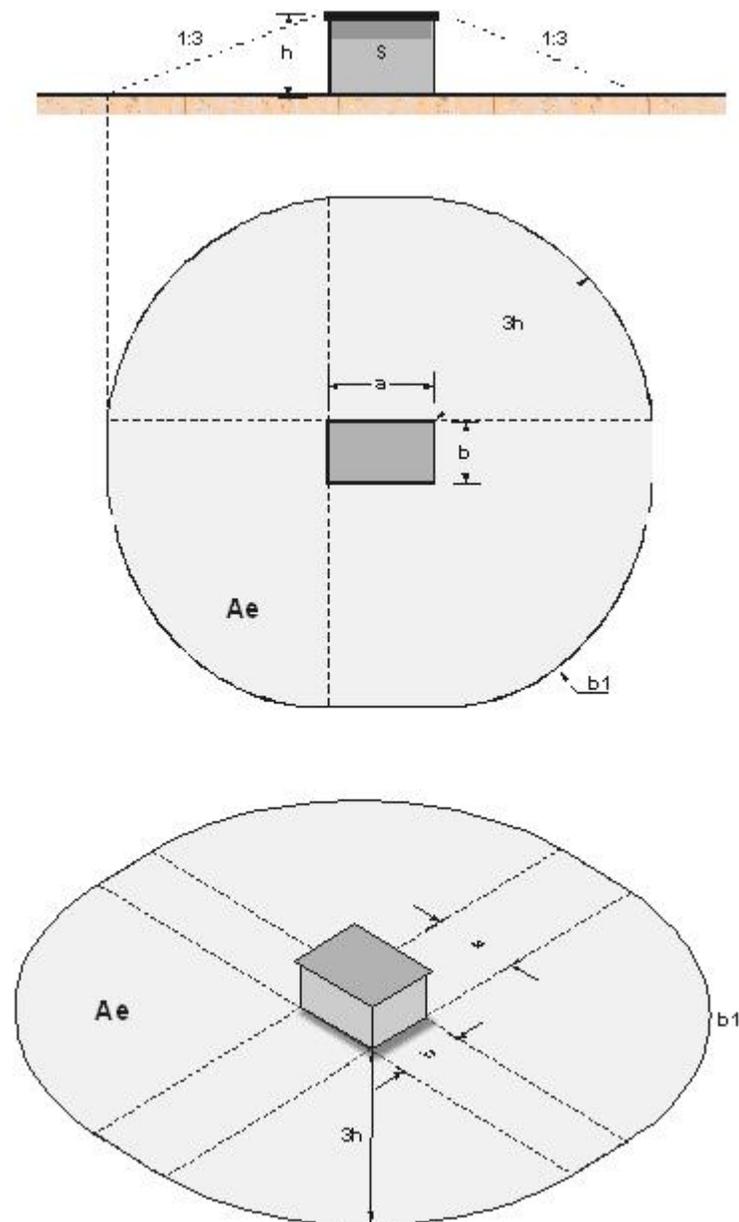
Area de captura equivalente para una estructura con techo plano y en terreno plano.
